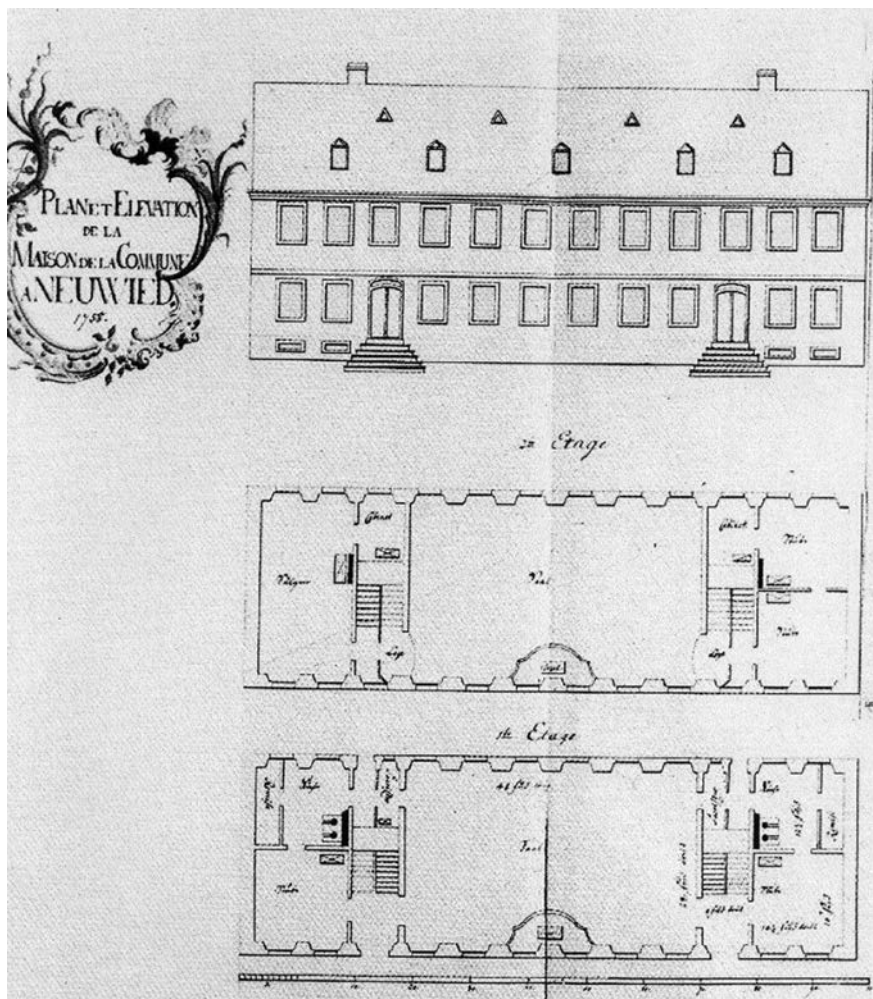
Plan et Elevation de la Maison de la commune a Neuwied, Entwurf für den Bau des Gemeinhauses mit Kirchensaal in Neuwied, Ansicht und Grundrisse des Erdgeschosses und der ersten Etage mit Angabe der Nutzung der Räume (UA, TS Bd. 1.64.b)
